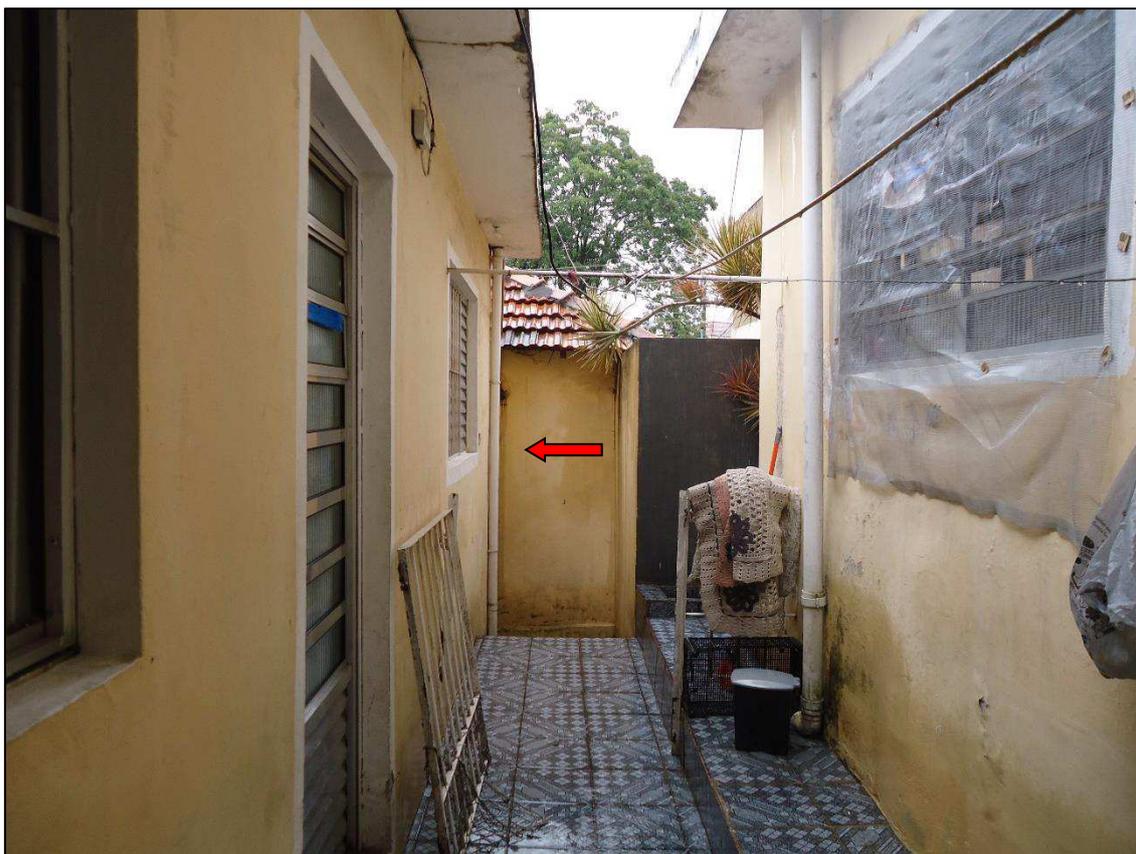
Vista do acesso às construções secundárias (1) e (2) no sentido oposto da Foto 35.
